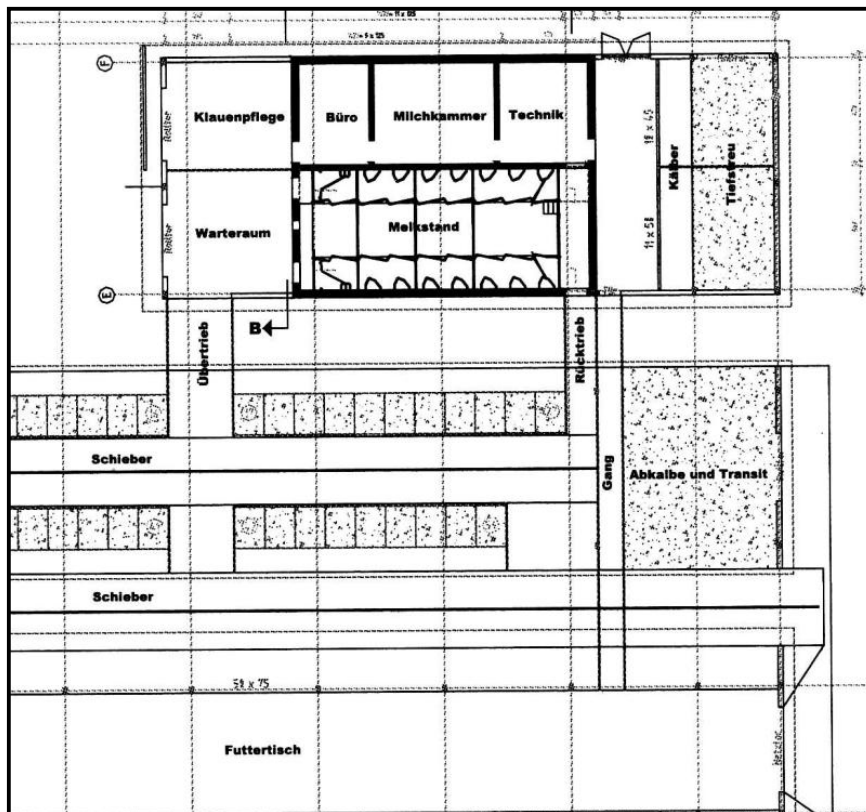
Grundrissbeispiel mit Abkalbebereich an der Giebelseite (Quelle: Fa. Kristen).
